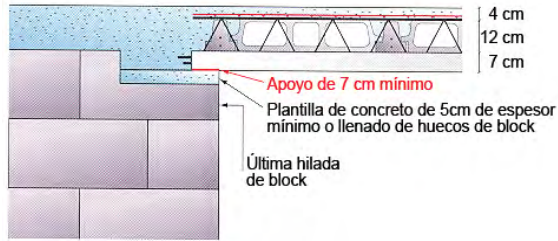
DETALLE DE APOYO PARALELO AL EJE DEL MURO DE CARGA
